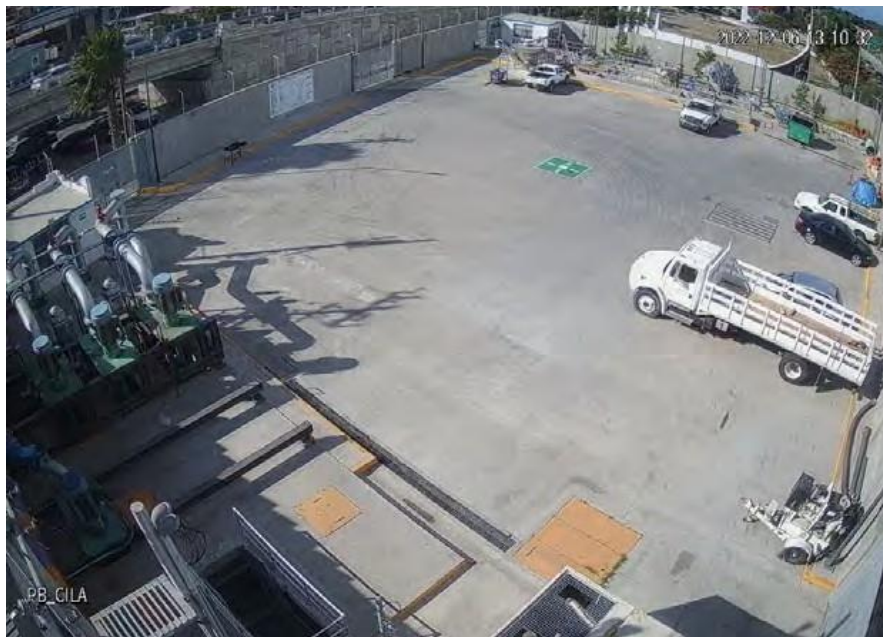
Enfoque de Cámara en Planta de Bombeo CILA
